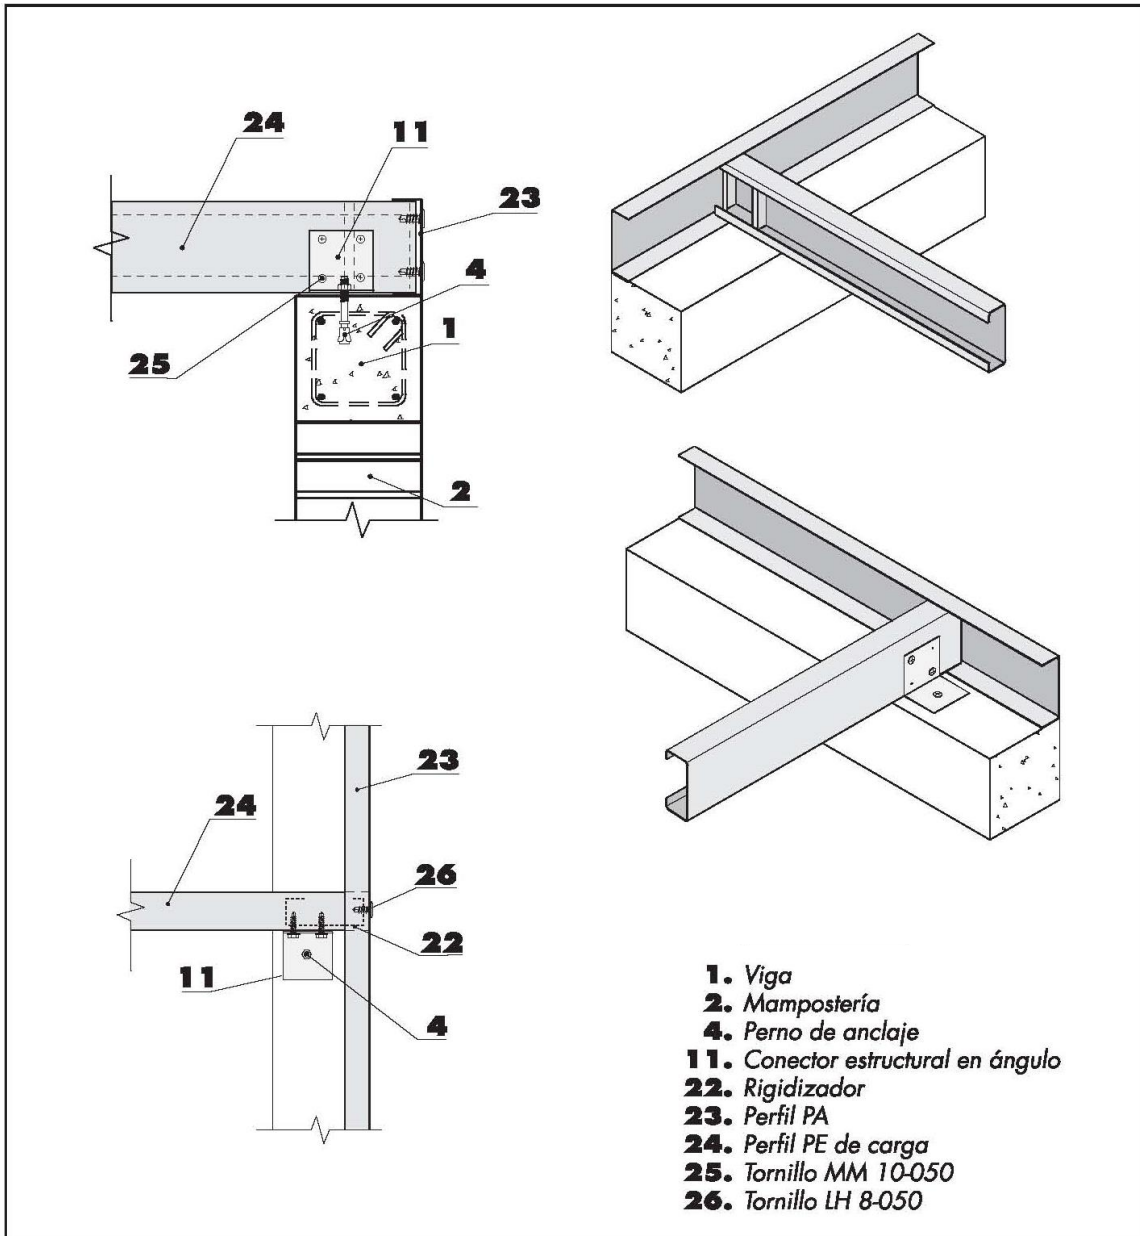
Detalle 1. Forjado. Anclaje sobre cemento. Encuentro entre perfil de carga y de amarre [87].
